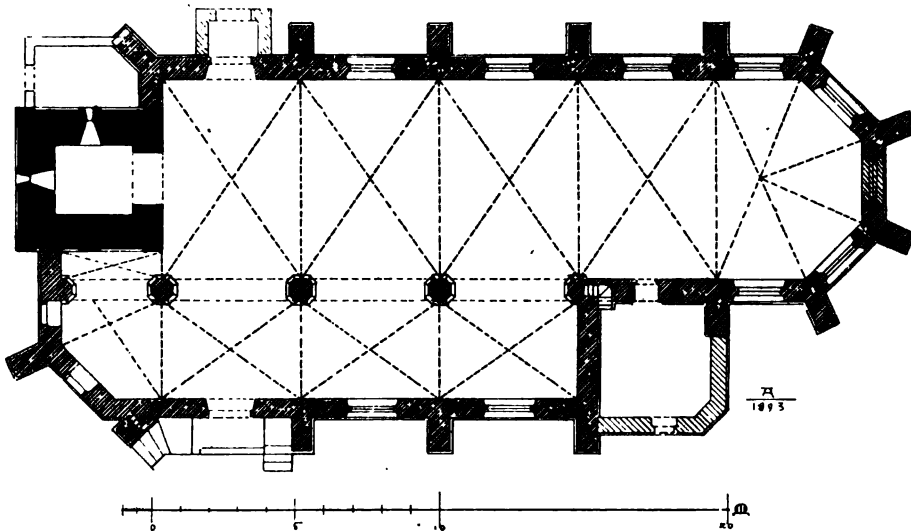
Königshoven. Grundriss der katholischen Pfarrkirche vor der Erweiterung.
